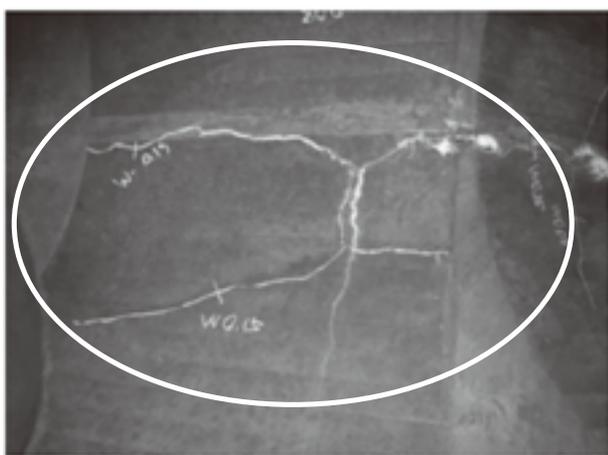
監査廊ひび割れ、エフロレッセンス
